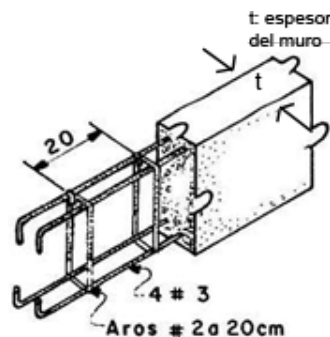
Armado de una viga de refuerzo a nivel de piso (Moas, 1993)
